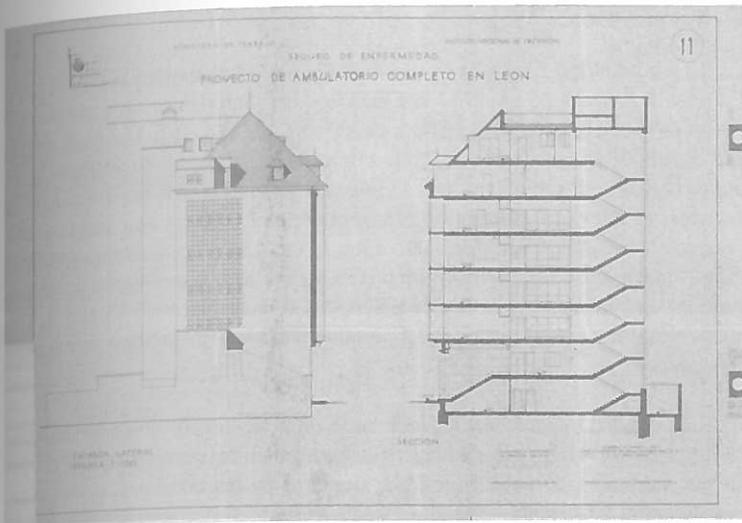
Ambulatorio Hermanos Larrucea, fachada lateral (norte) y plano de sección, Marcide Odriozola, 1952. Fuente: AHML.
